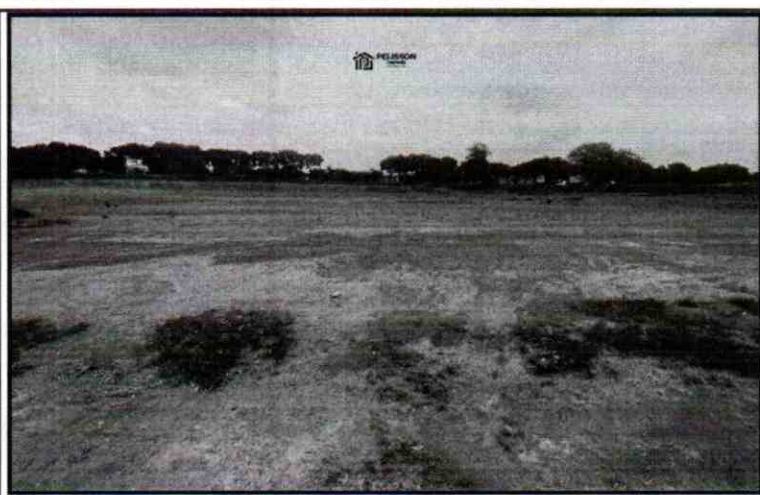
Mostra vista parcial do terreno na cota mais baixa dos fundos para avenida
